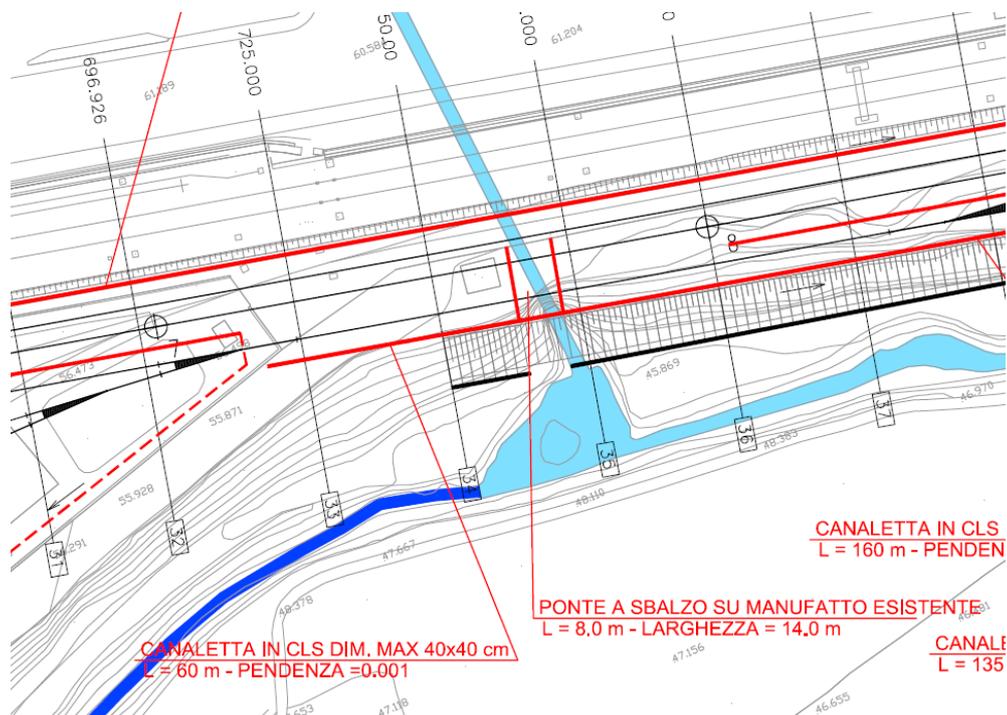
Stralcio planimetrico stato di progetto - Torrente Valpantena
